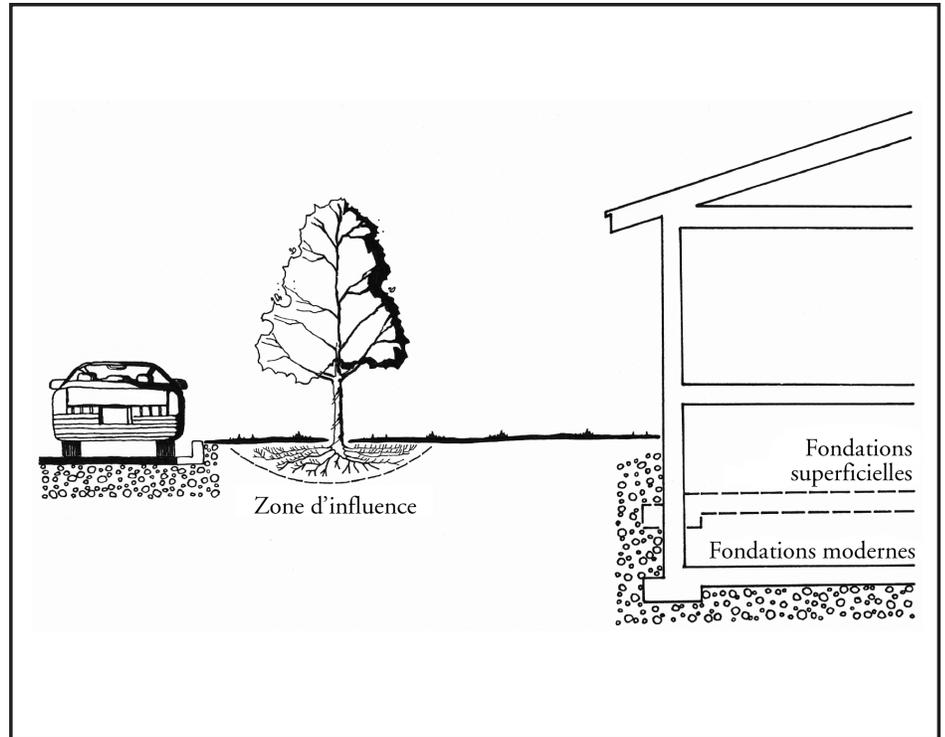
Rapport entre un jeune arbre et les fondations d'un bâtiment
